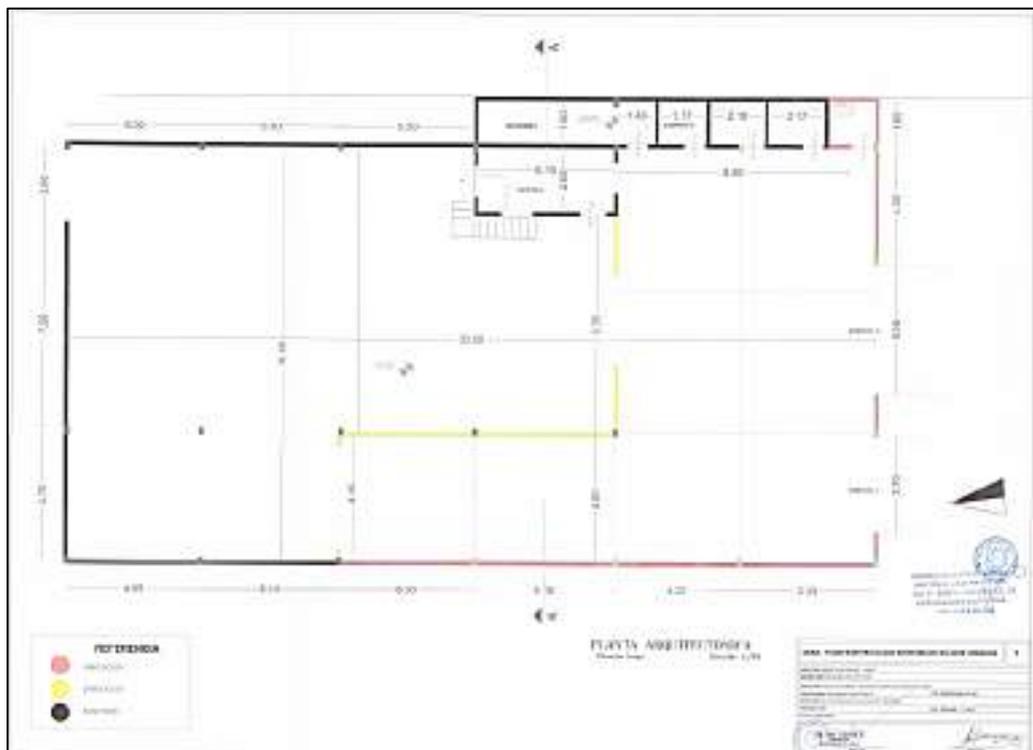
Plano de arquitectura - Planta Baja, aprobado por la Municipalidad.
